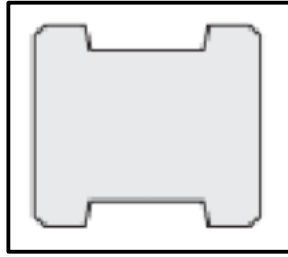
Orelles d'un pilar (Empresas Construcción, 2013)
